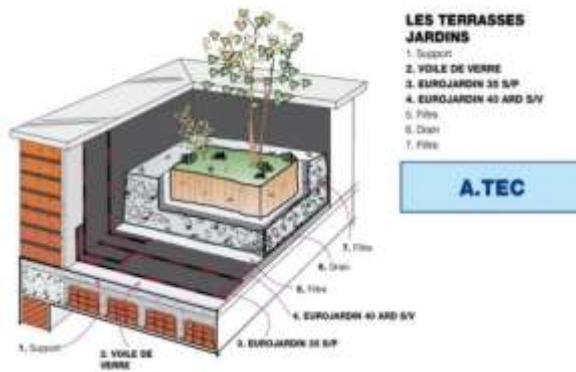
Terrasse jardin détail constructif, Source : auteur, 2021
